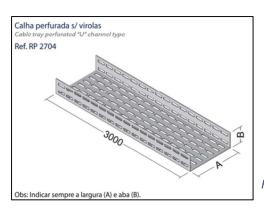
Eletrocalha perfurada para instalação suspensa na laje
